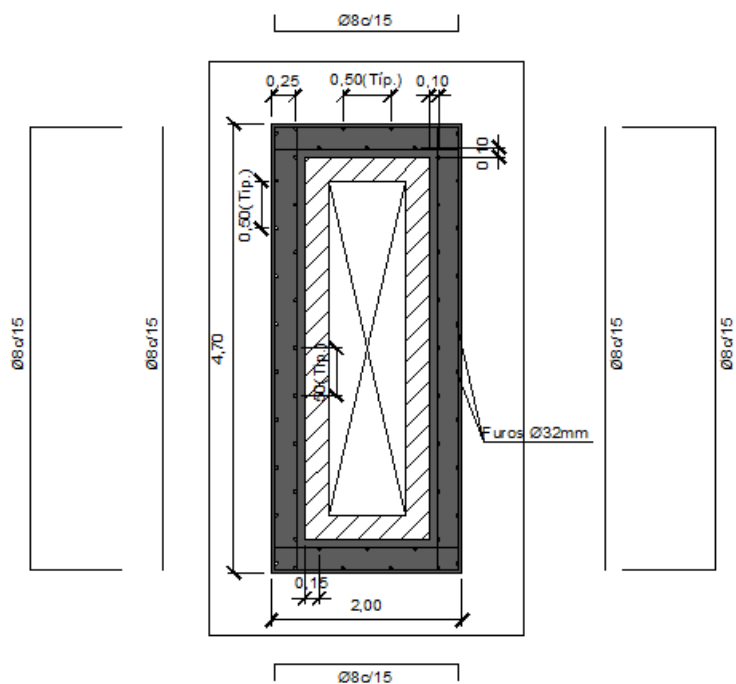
Seção transversal típica do pilar para o reforço proposto
